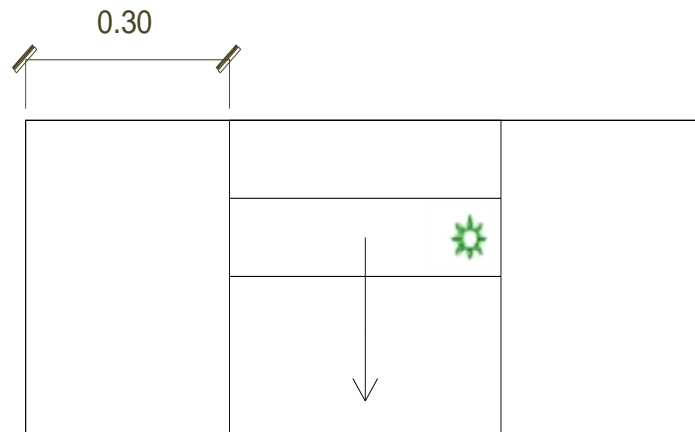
localização do ensaio VAF1H5Y30 (dimensões em metro)
